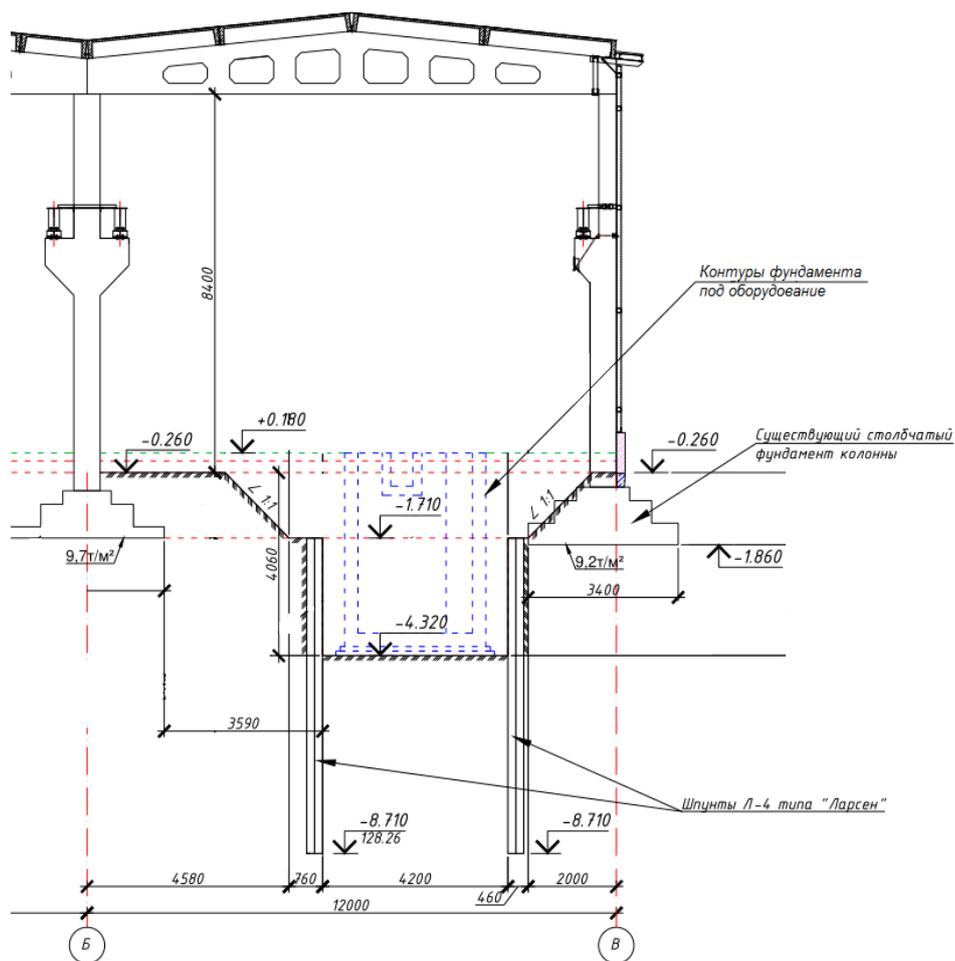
Проектное решение метода производства работ при устройстве фундамента под оборудование
